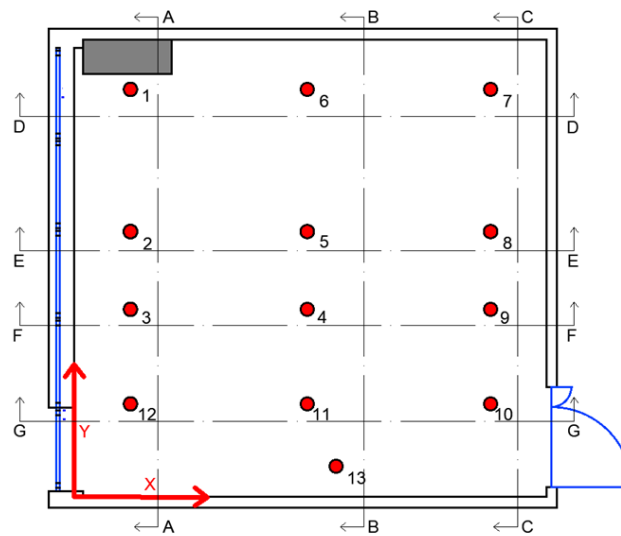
Planimetria con individuazione delle sezioni di riferimento: A-A; B-B; C-C
